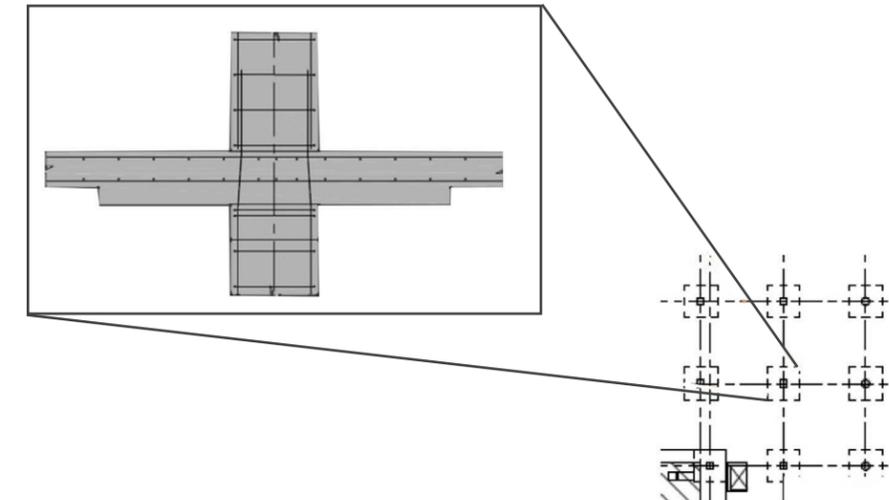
Detalle de cimientos. Fuente: Stanley Beaman and Sears.
